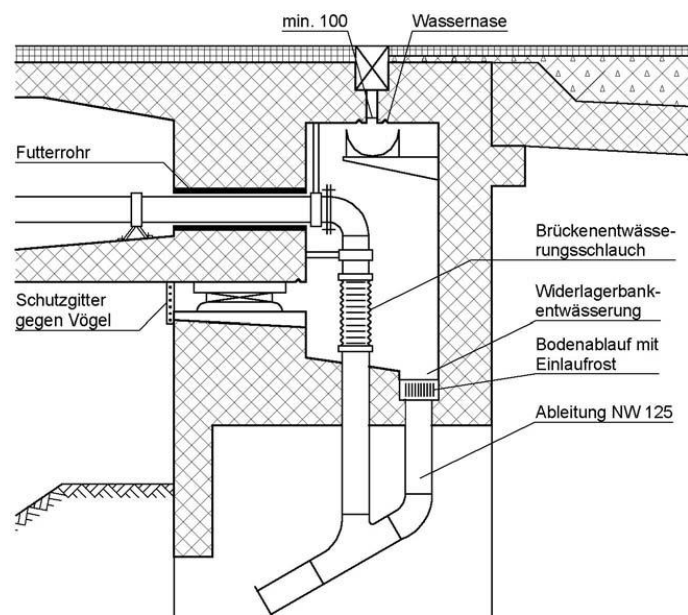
Sammelleitung mit Brückenentwässerungsschlauch und Fahrbahnübergangsentwässerung am Brückende, Abb. 11 in [8 S. 16]
